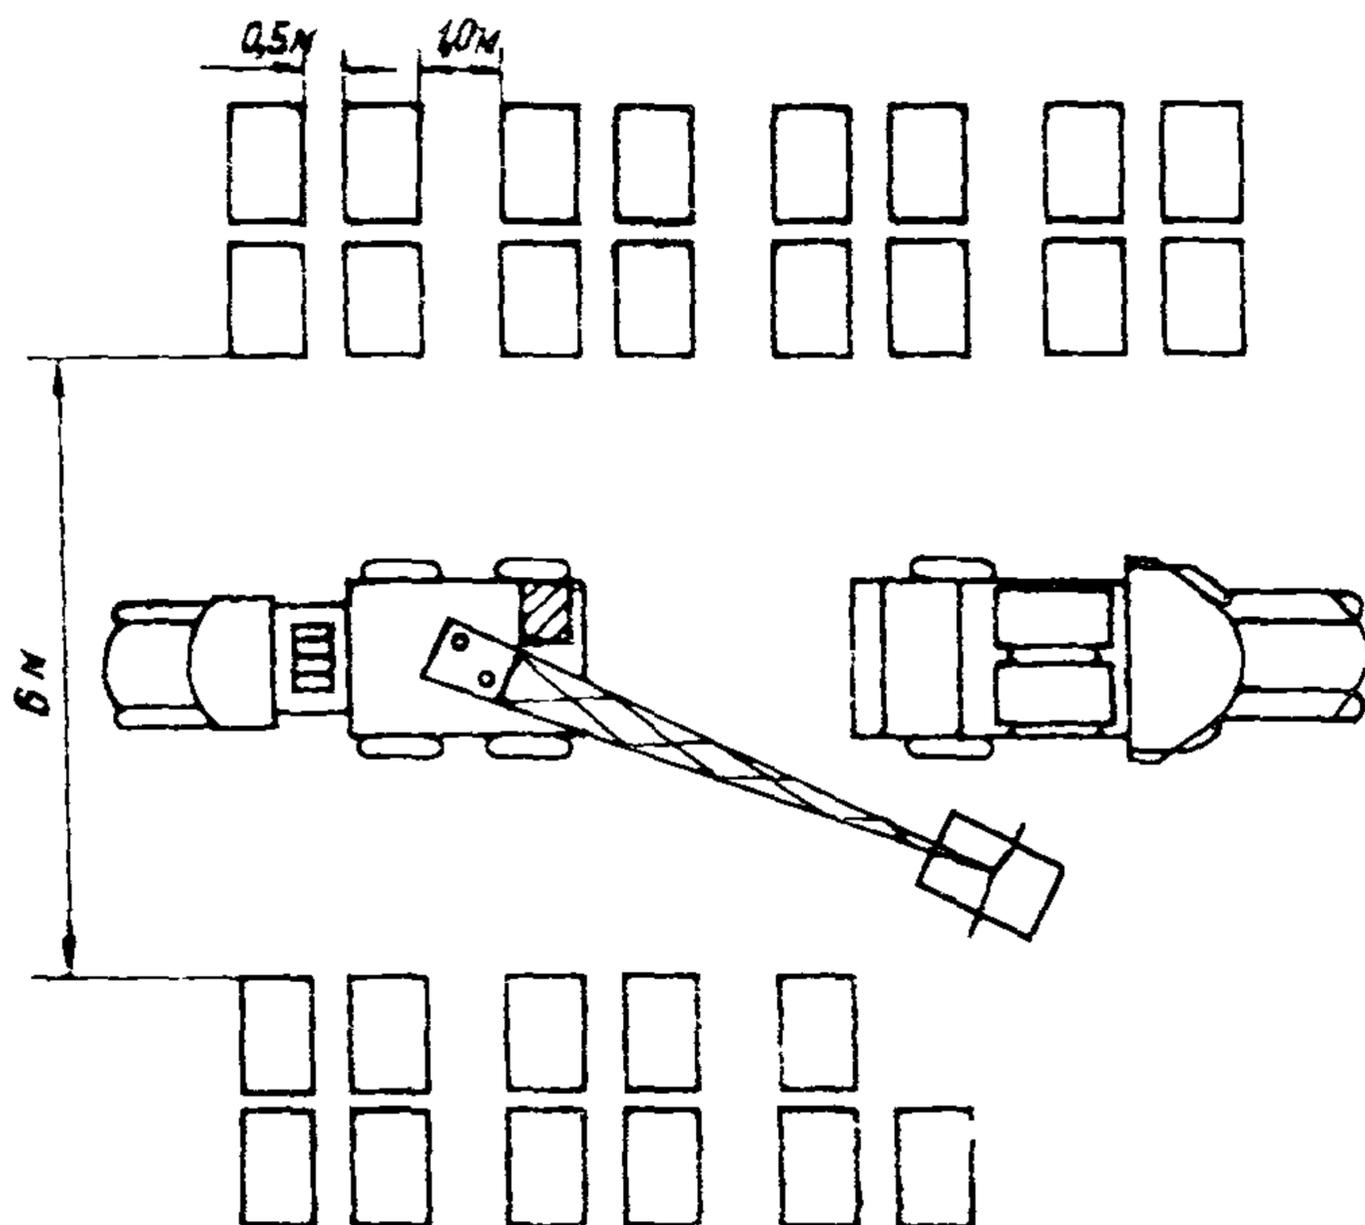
Размещение барабанов с кабелем на кабельной площадке
